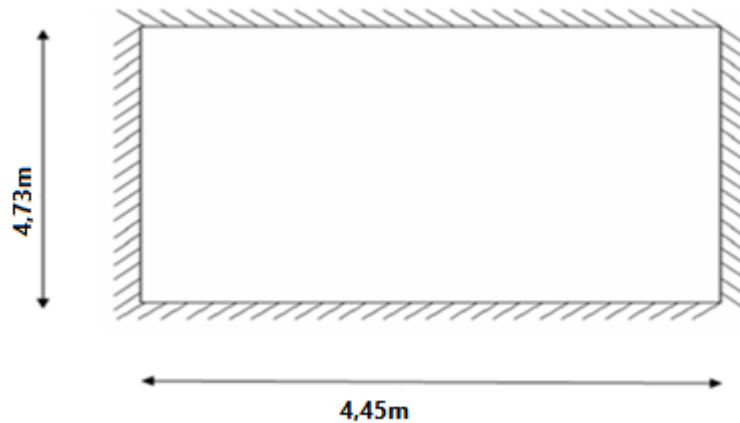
Dimensions d'une dalle pleine rectangulaire.
